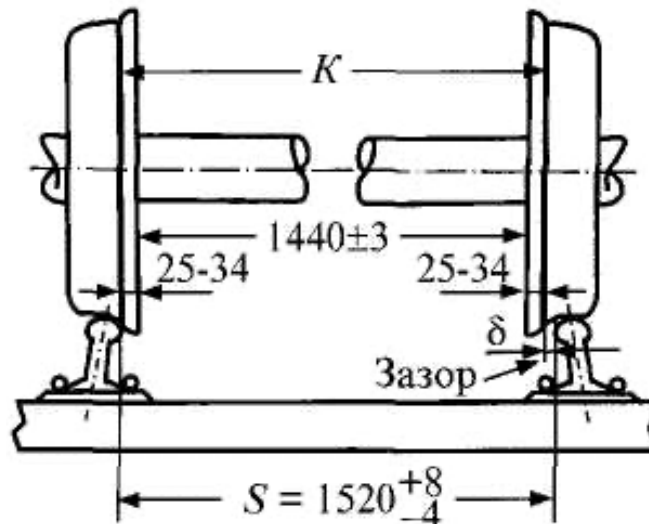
Соотношение размеров и допусков колесной пары или ширины колеи
